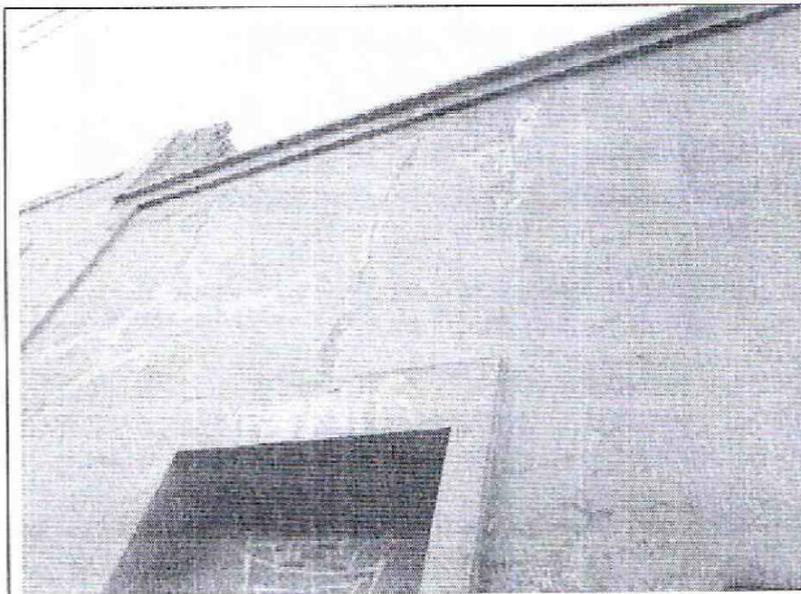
Grieta vertical en parte alta de porción embebida.
